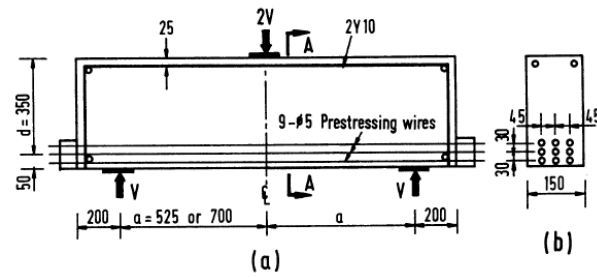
Detalhamento das vigas-paredes ensaiadas por TAN e MANSUR (1992)
